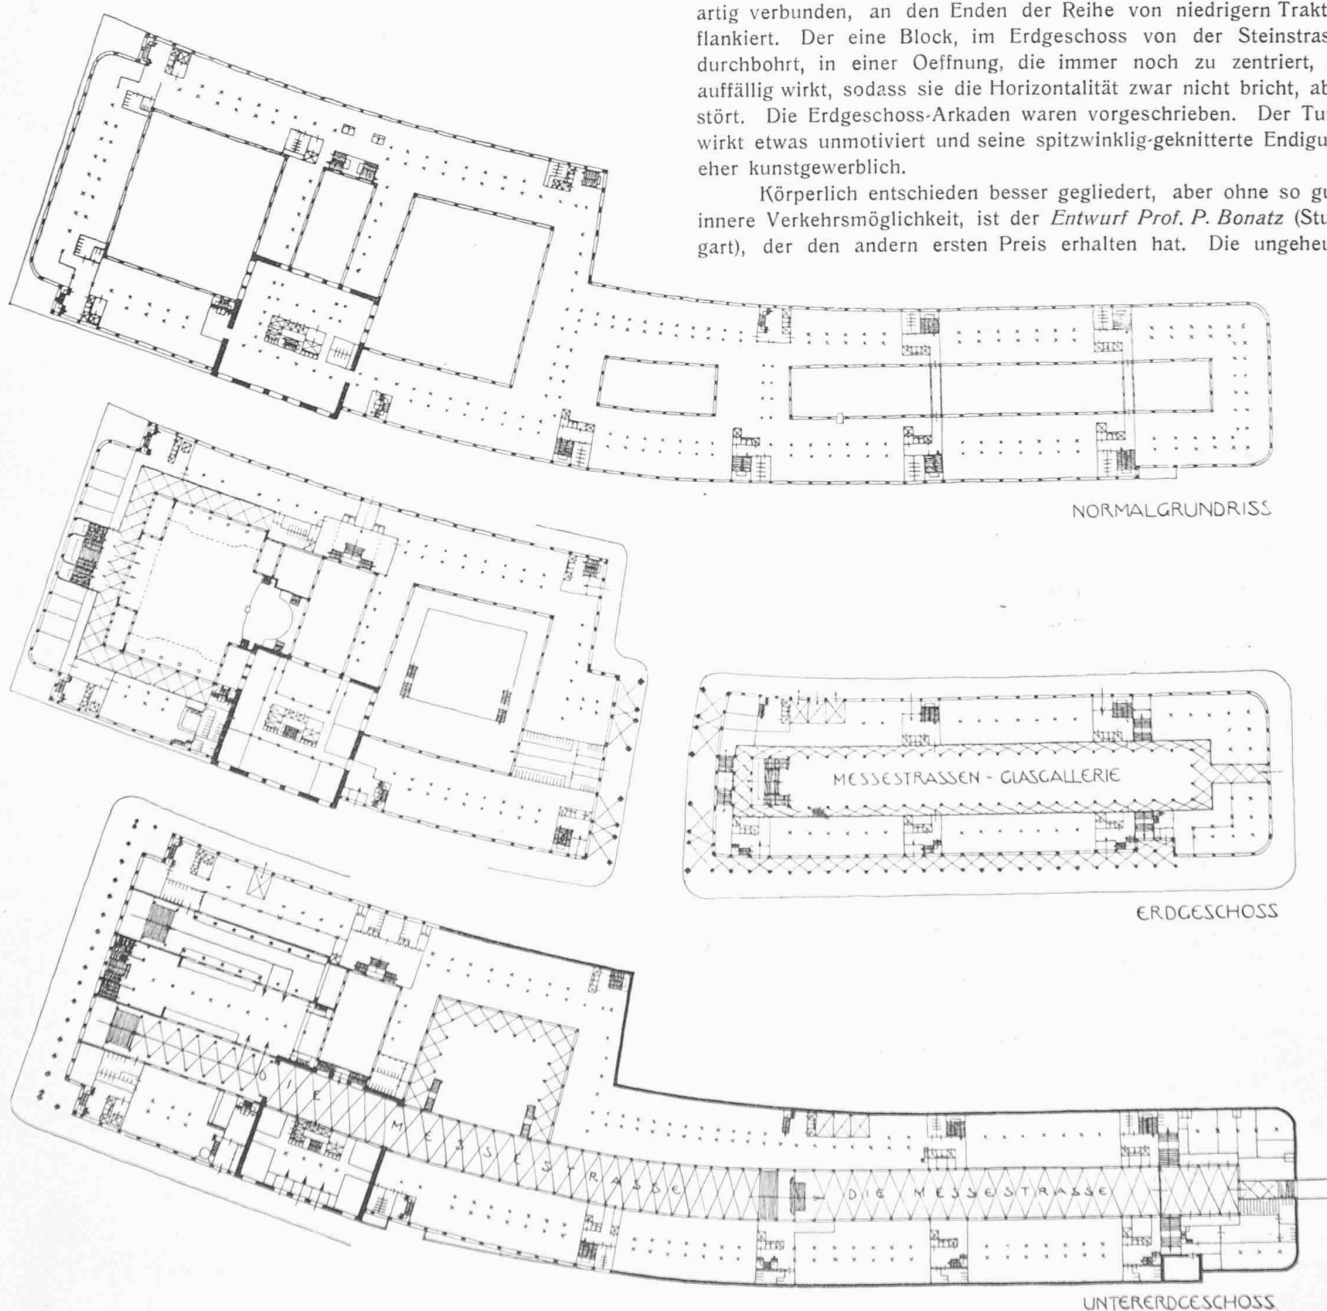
bis 5. Grundrisse zum Entwurf H. Distel. — Masstab etwa 1:1900.
